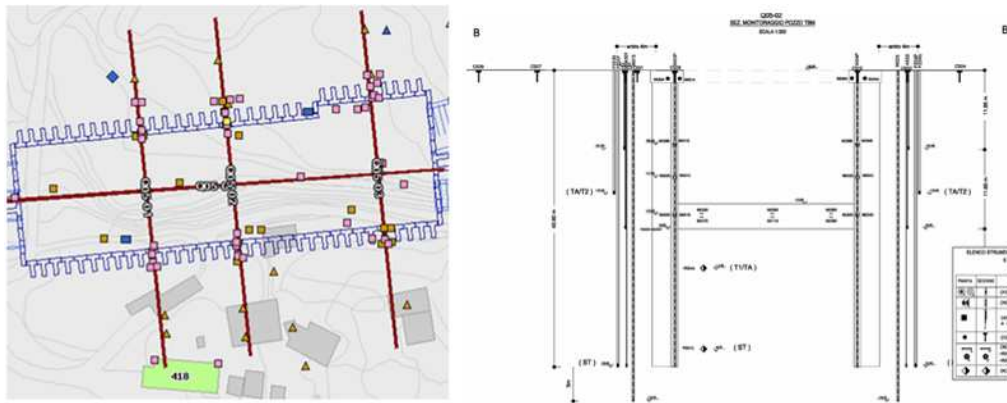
Pozzo TBM Malatesta: Planimetria e sezione di controllo tipo
